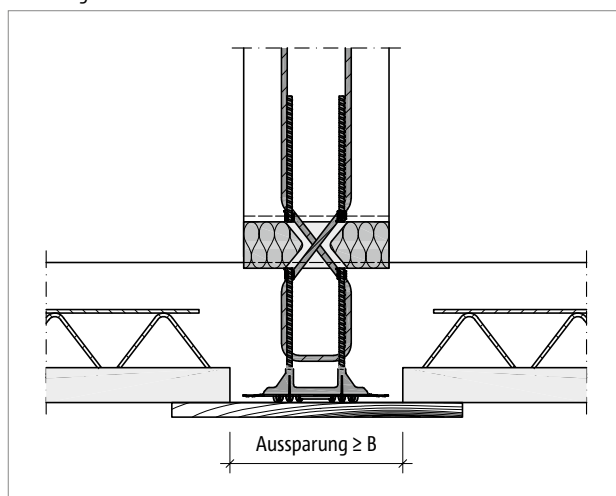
Schöck Sconnex® Typ W: Schematische Darstellung (Einbaustand) Schöck Sconnex® Typ W bei Halbfertigteildecken und Aufdeckendämmung
